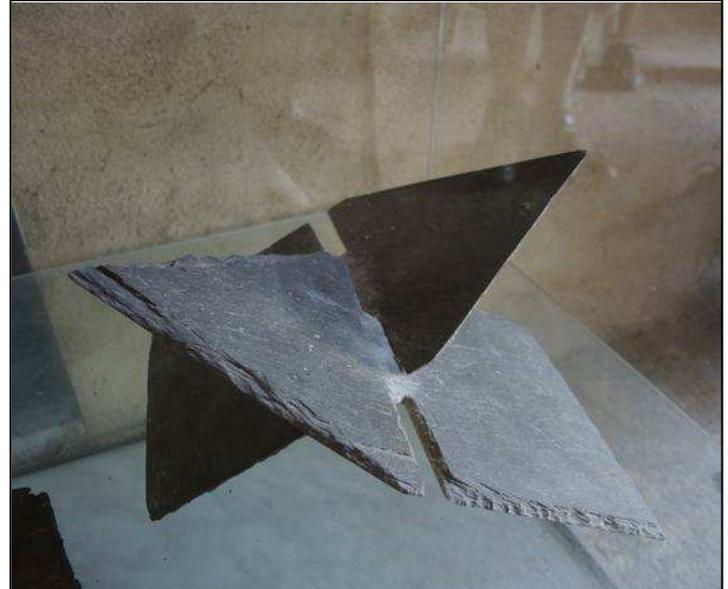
détail de l'assemblage des ardoises sur faitage à lignolet croisé
